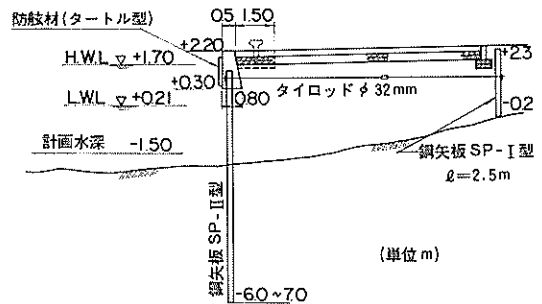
荻浜港小積物揚場 (-1.5 m) 標準断面図
